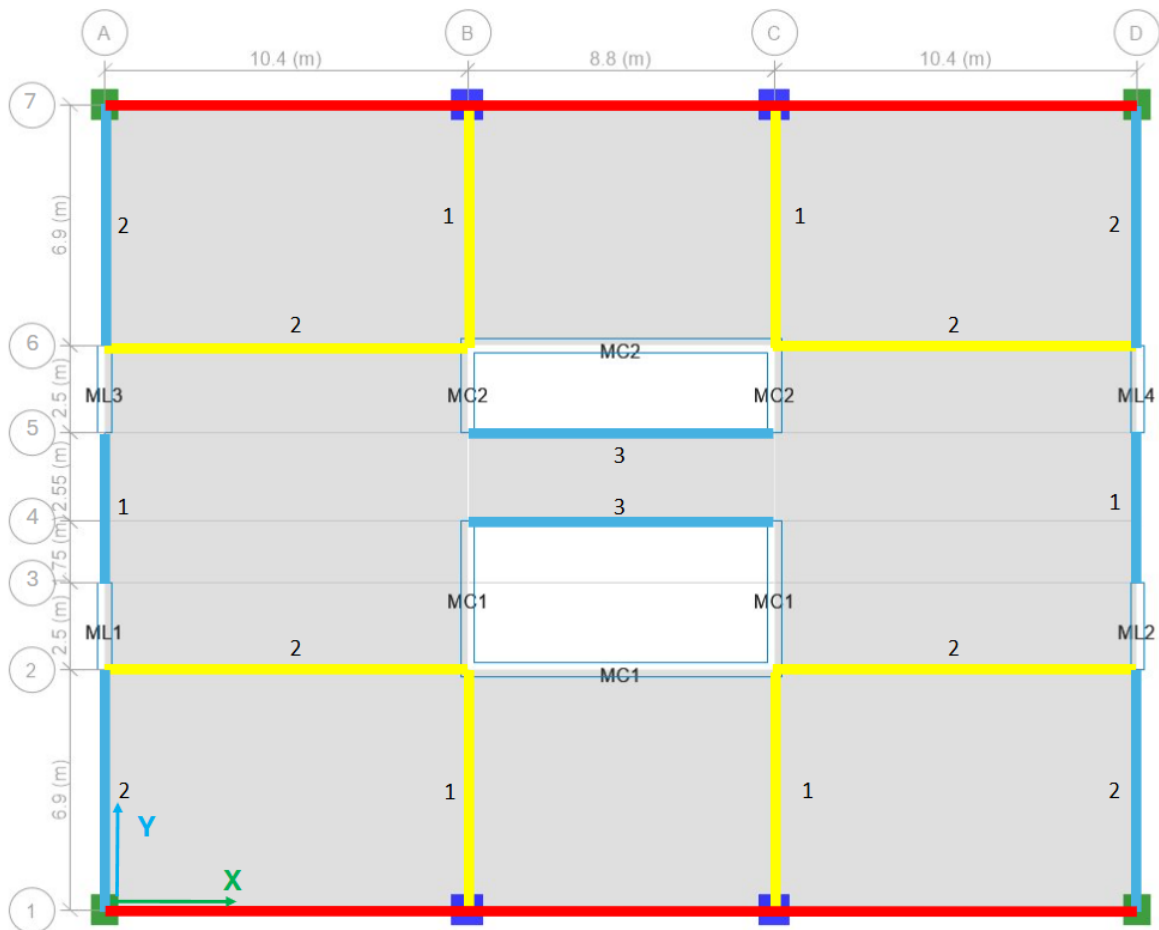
Vista en planta de estructura en estudio indicando los diferentes elementos estructurales.
